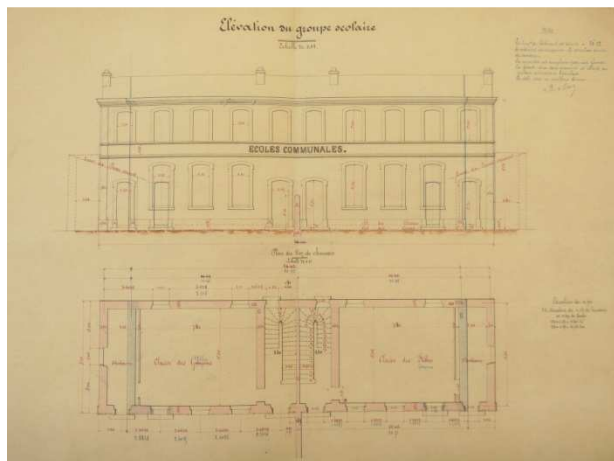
Plan général, Boeuf Barthélémy (architecte).
